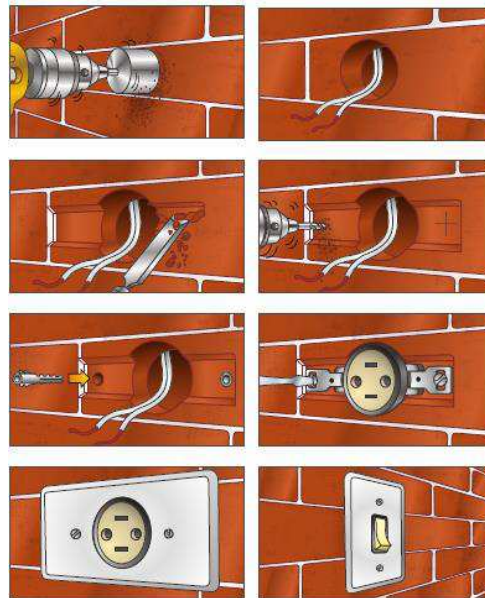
Instalações elétricas em tijolos de solo-cimento.
